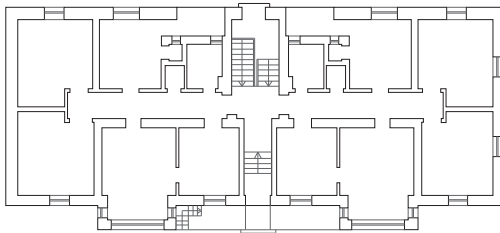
Grundriss Erdgeschoss des Rione „Battisti“
